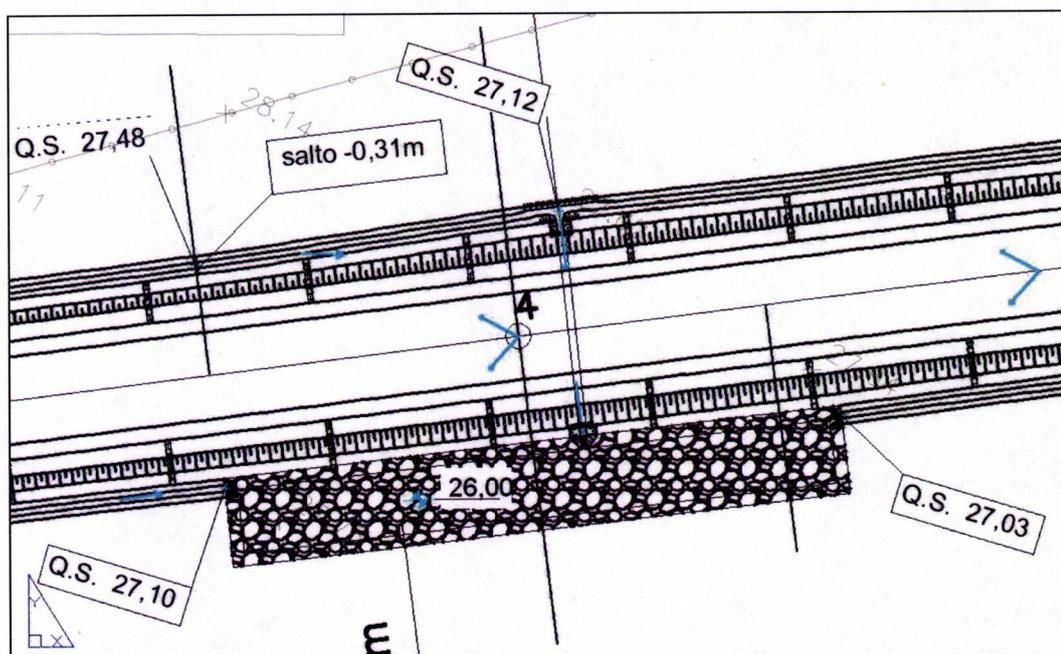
schema planimetrico del sistema di collettamento e smaltimento delle acque meteoriche
